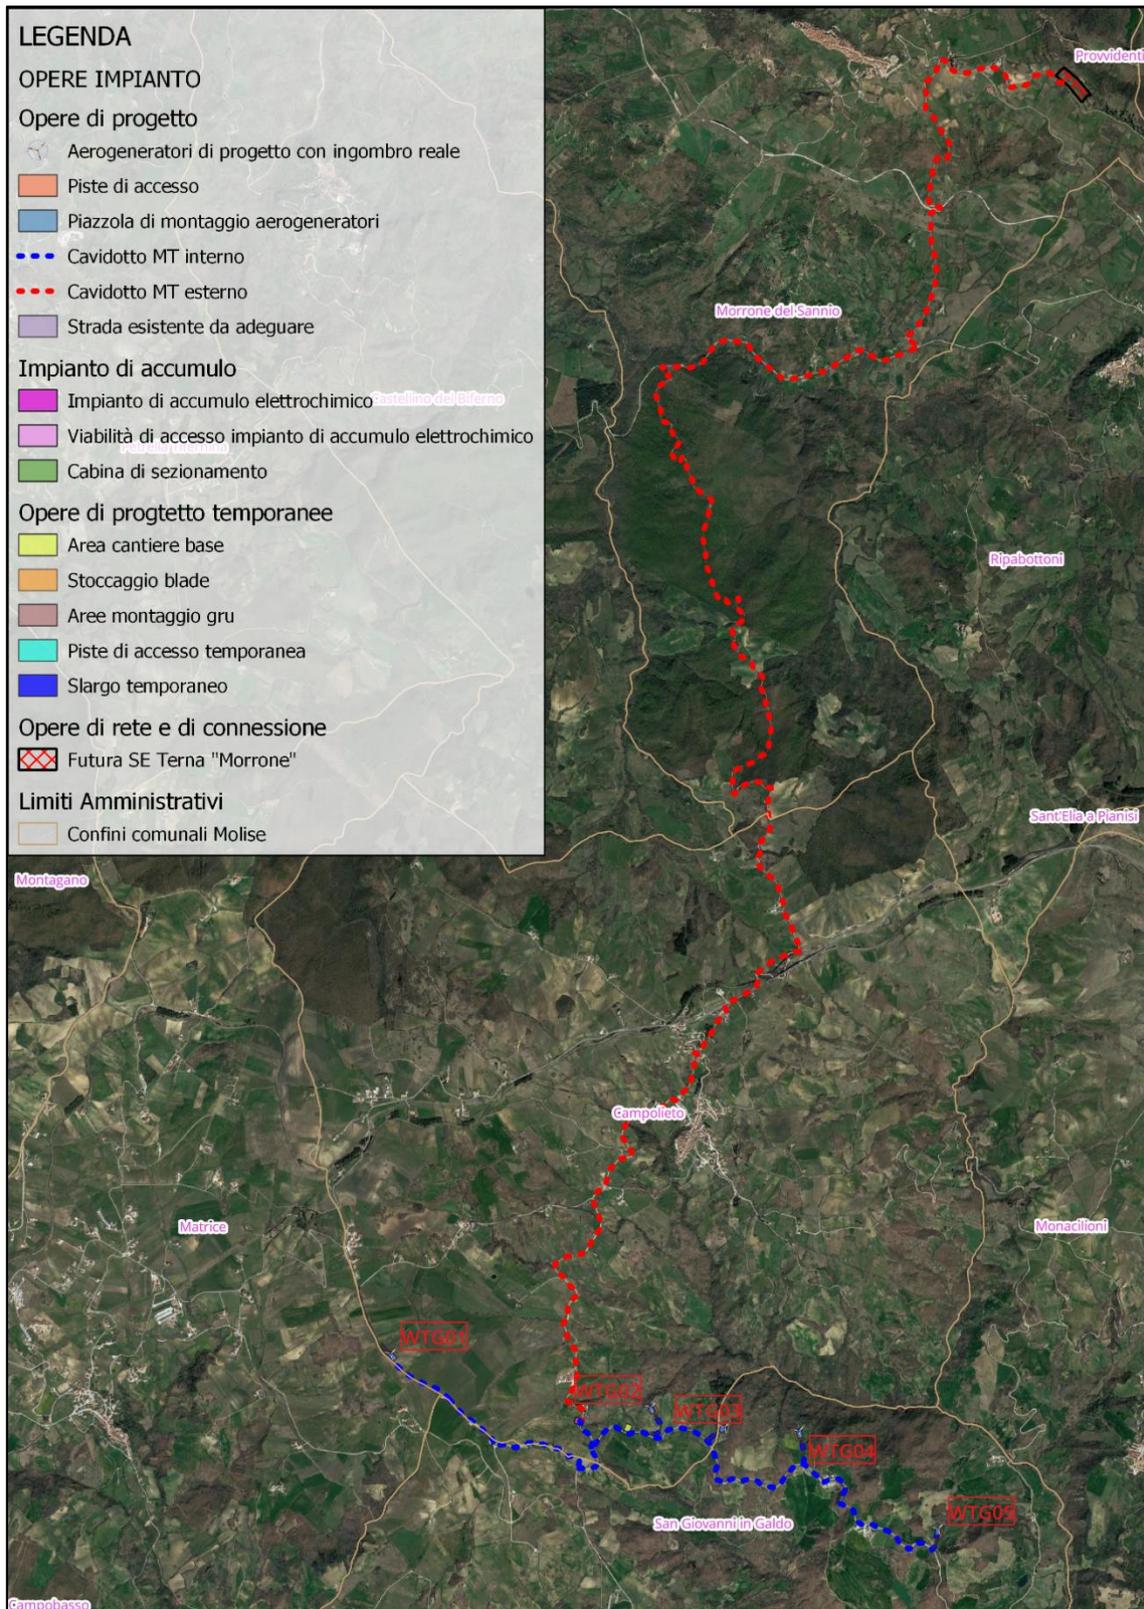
Ortofoto dell'area di impianto e tracciato delle opere di connessione
